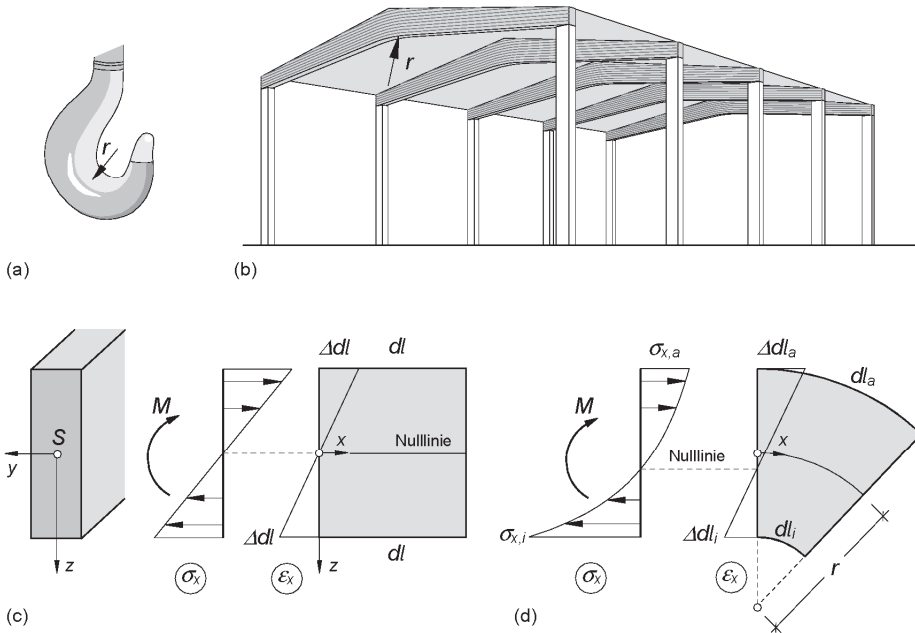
(a) Kranhaken, (b) gekrümmter Brettschichtholzbinde einer Hallenkonstruktion, Spannungen und Dehnungen (c) eines geraden Bauteils und (d) eines gekrümmten Bauteils
